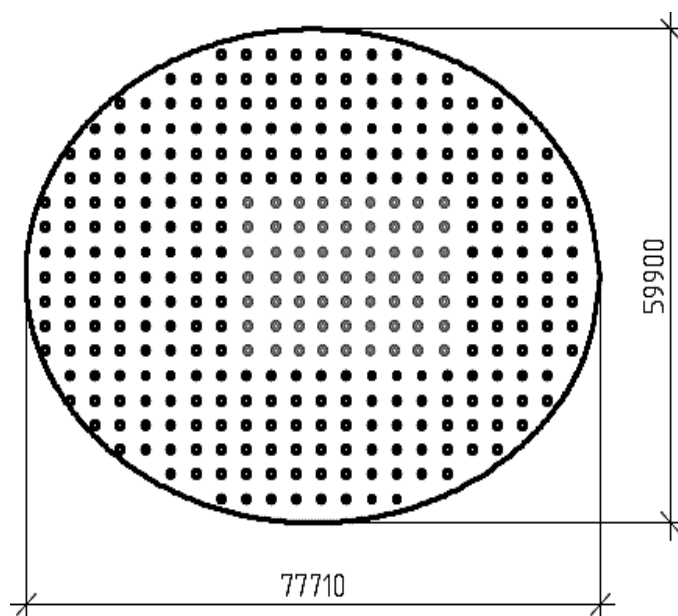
Опалубочне креслення монолітної плити фундаменту
